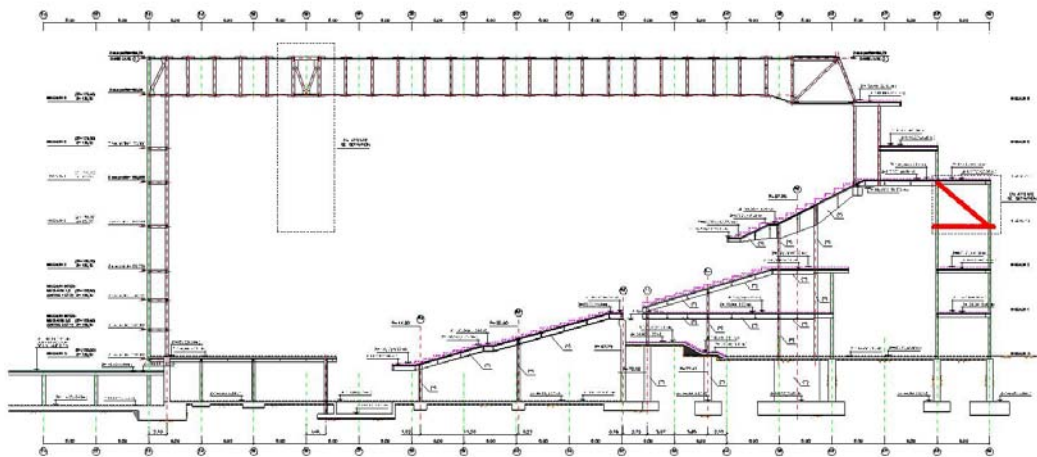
Corte por el eje del Auditorio, y vista de la cubierta.
